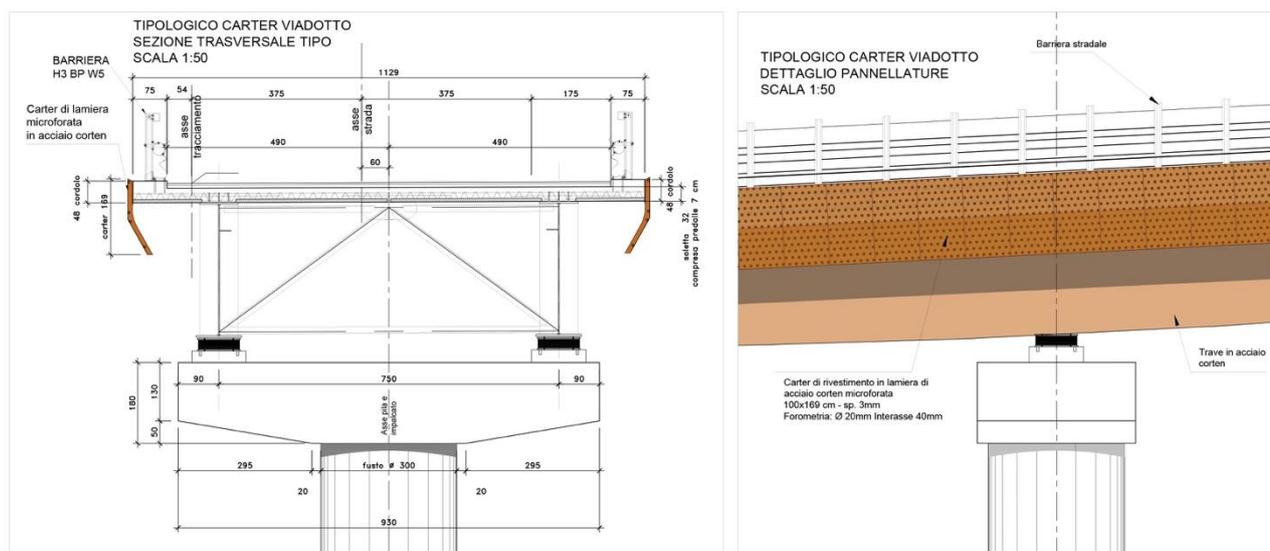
Sezione trasversale e longitudinale tipologiche dei viadotti
